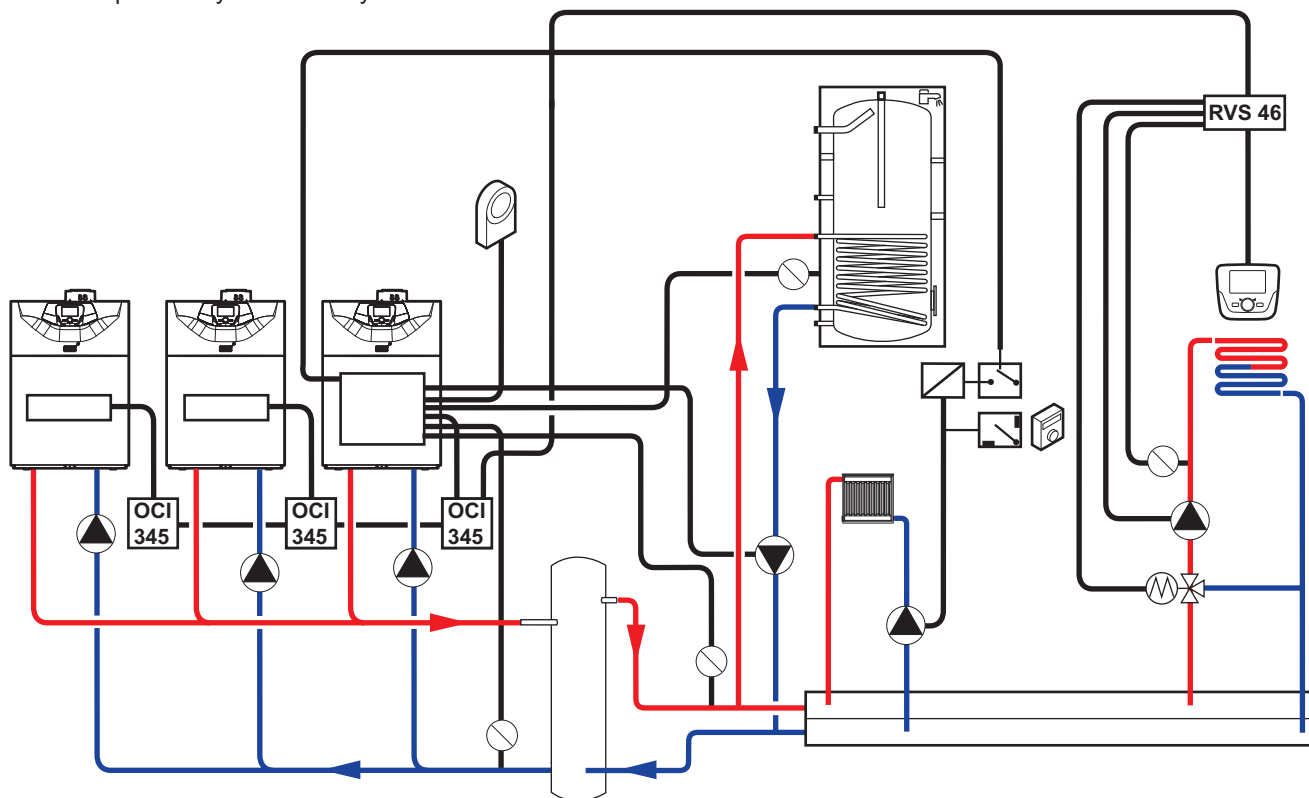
Příklad zapojení pro kotle v kaskádě se zásobníkem TUV a několika topnými okruhy s prostorovými termostaty
